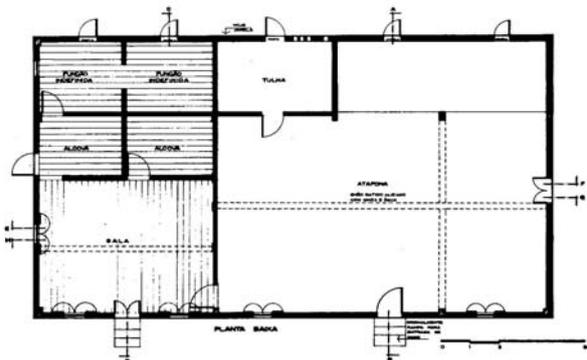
Planta-baixa da Edificação Principal (Weimer, 2005)
